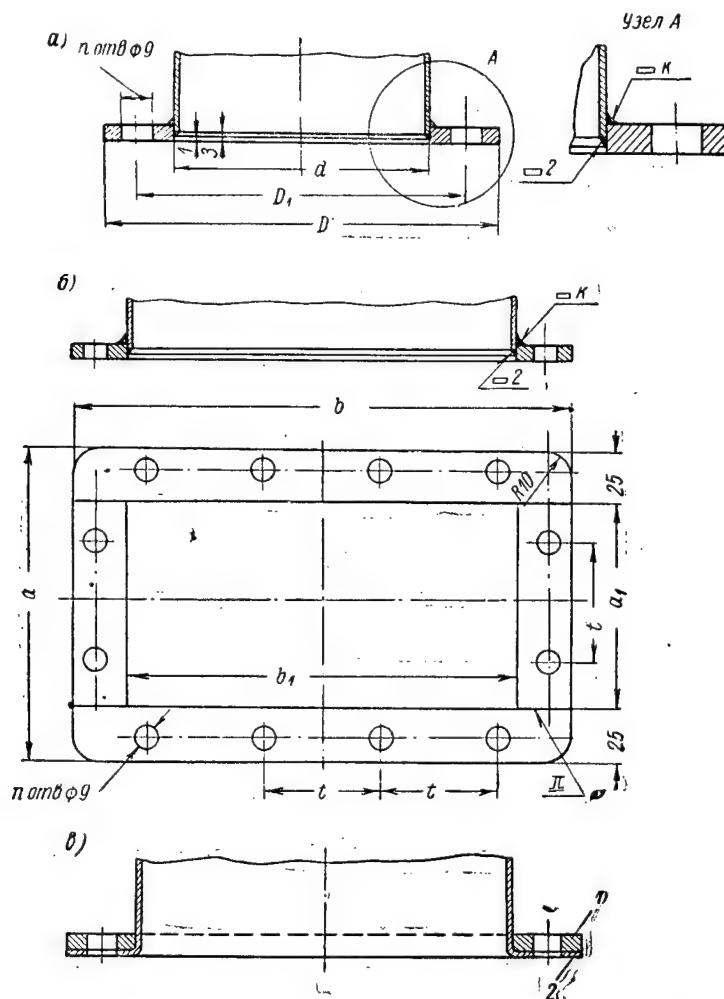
Фланцы вентиляционные трубные: а — круглый; б — прямоугольный; в — накладной.
